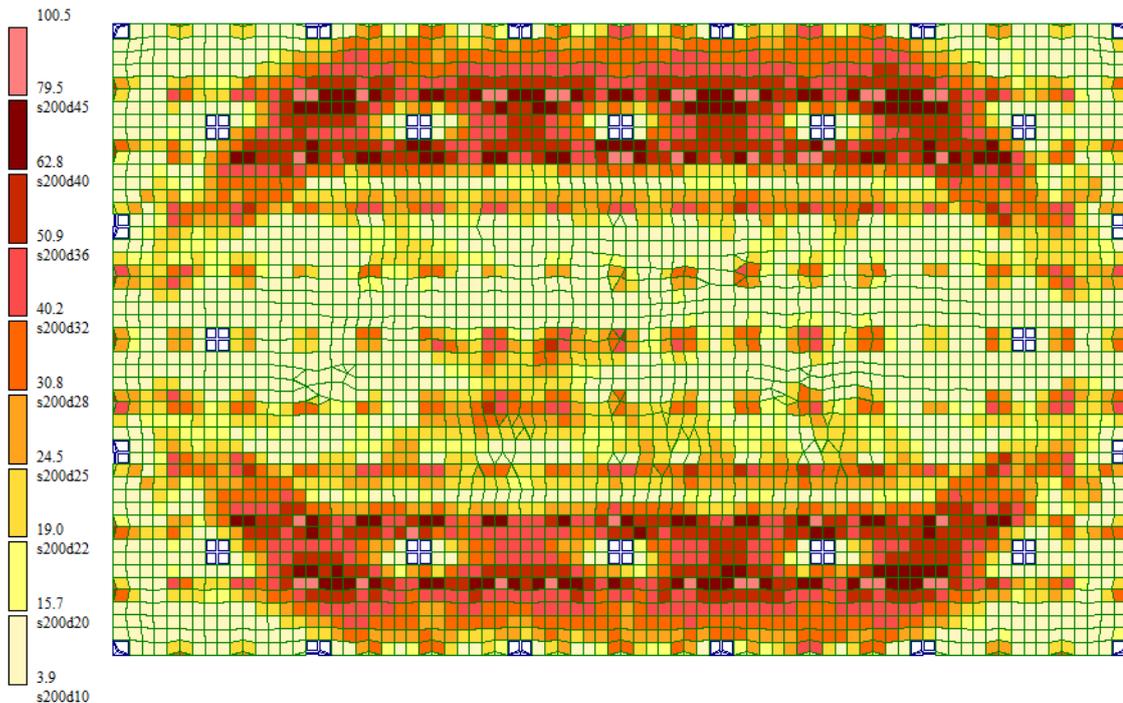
Схема армирования верха фундаментной плиты по оси OY
